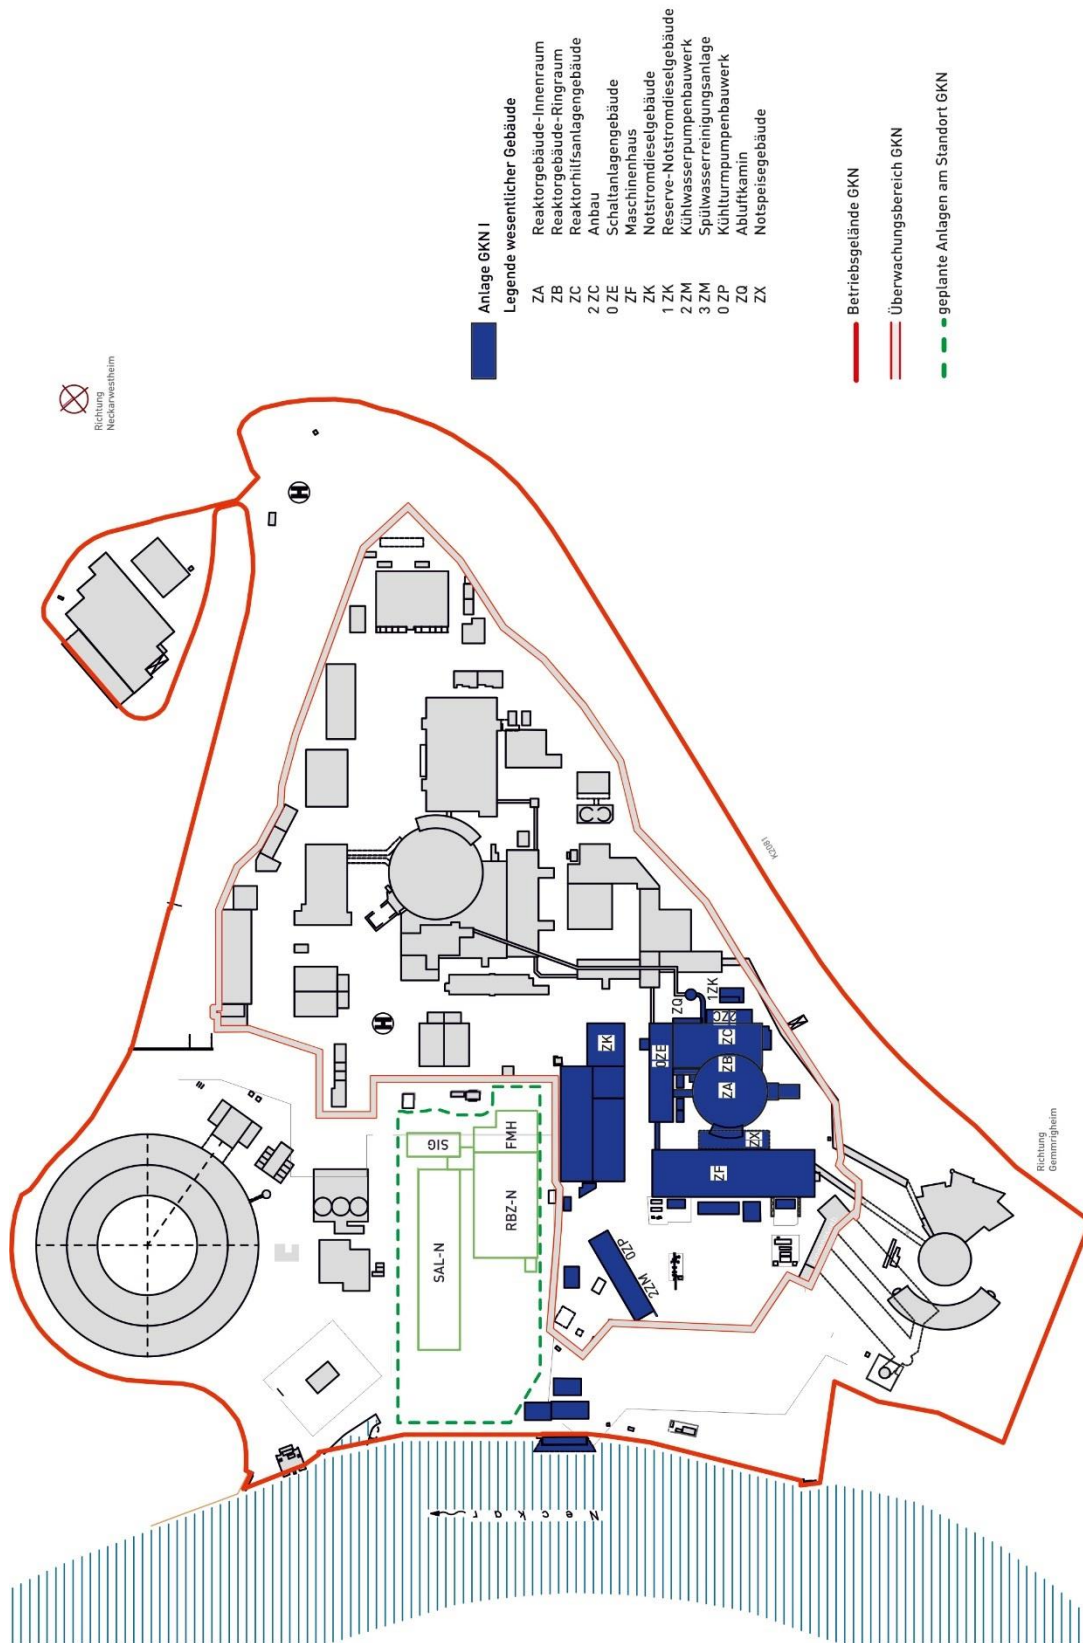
Übersichtslageplan des Standortes GKN mit RBZ-N und SAL-N
